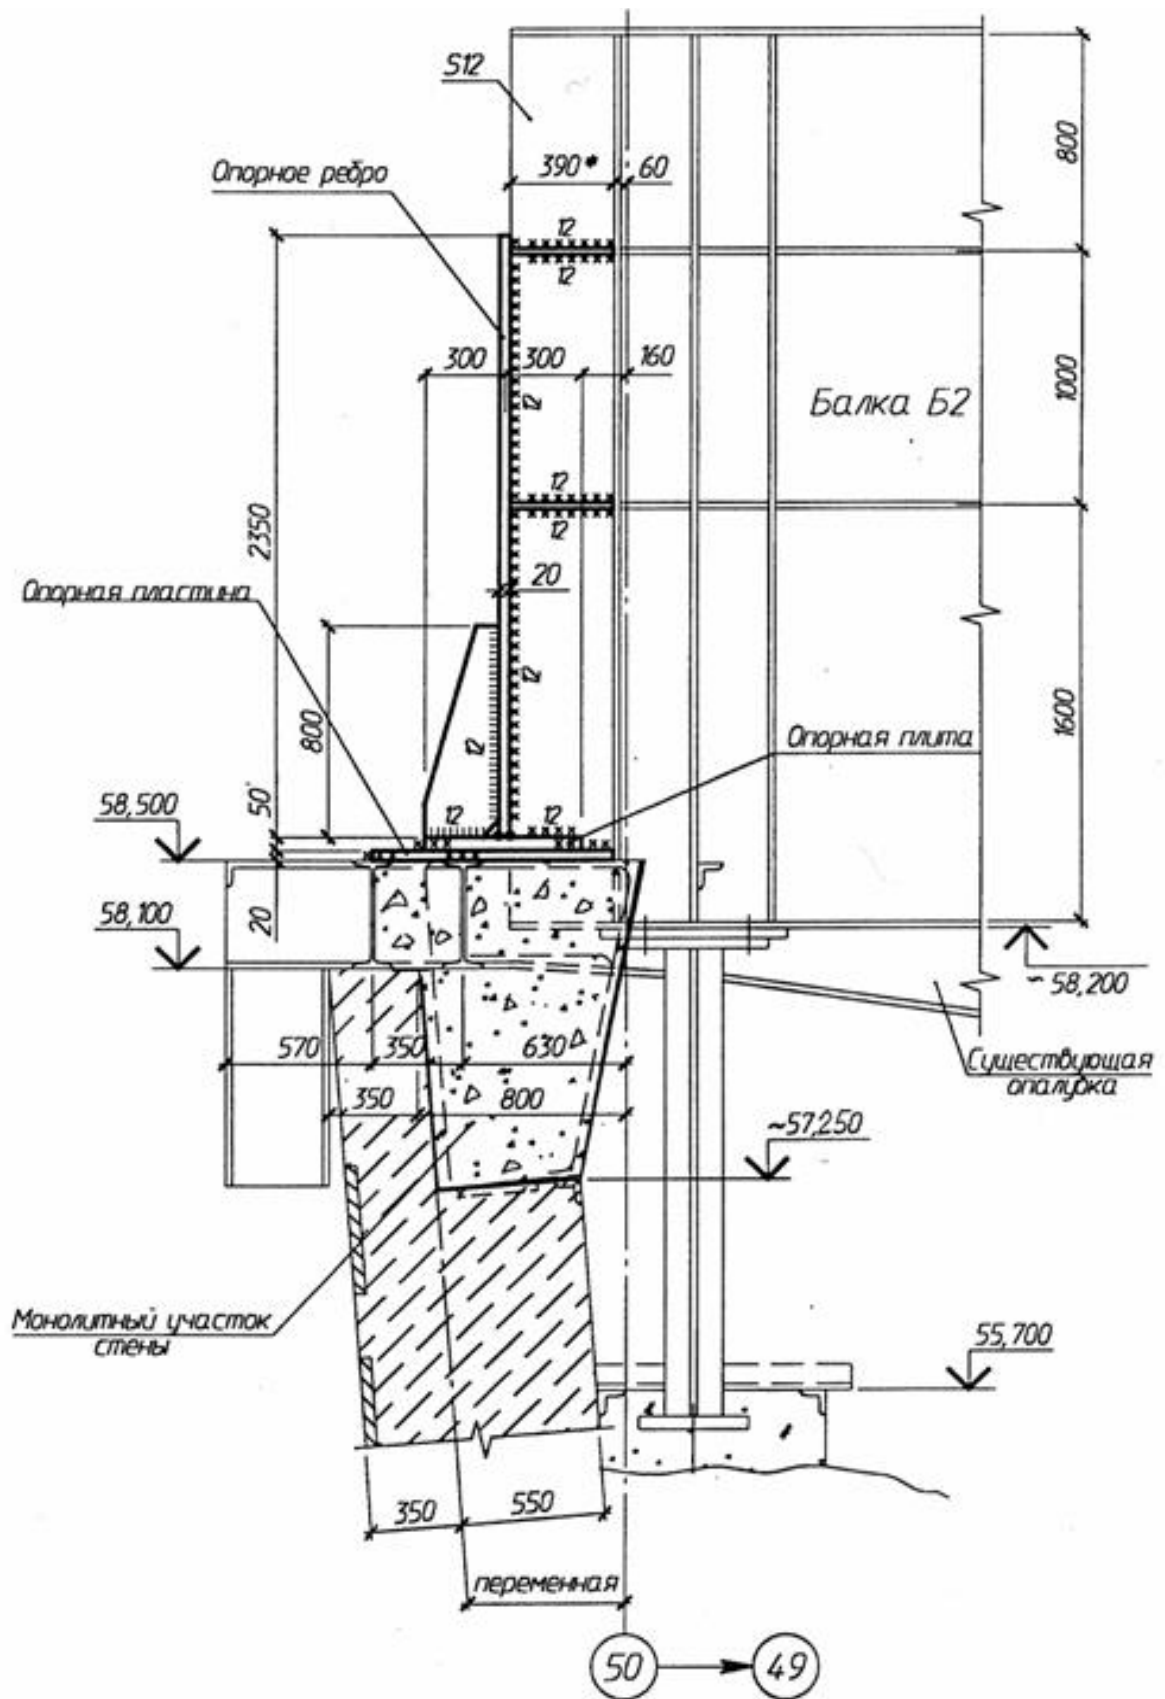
Усиление опорных частей балок Б2 и железобетонной стены по оси 50 в месте опирания на нее блока балок Б2 (ряд Ж).
